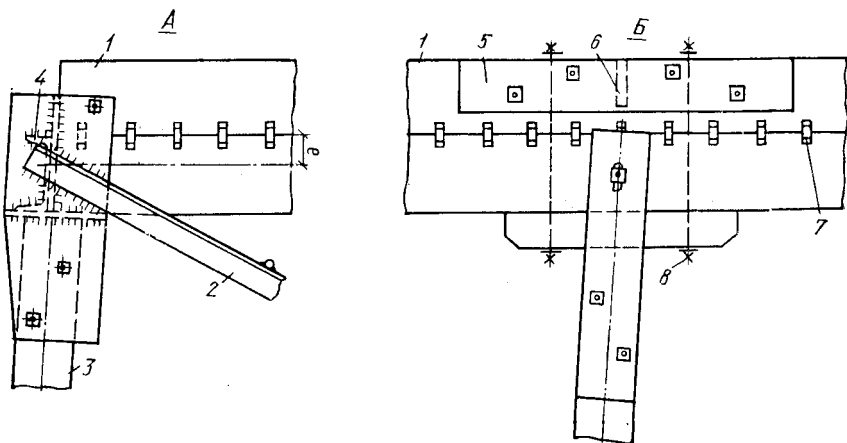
Узлы металлодеревянной фермы с брусчатым верхним поясом на пластинчатых нагелях (по схеме рис. 9.1):
